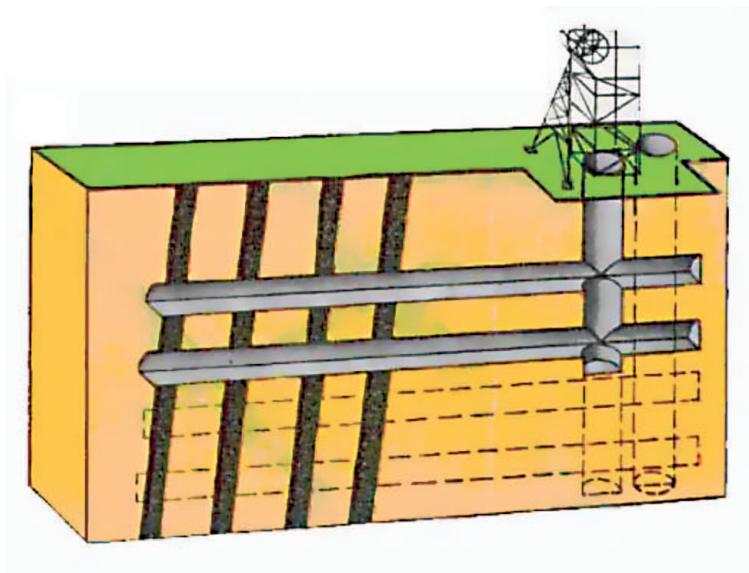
Схемы вскрытия шахтного поля свиты крутых пластов вертикальными стволами с этажными квершлагами и углубкой стволов
